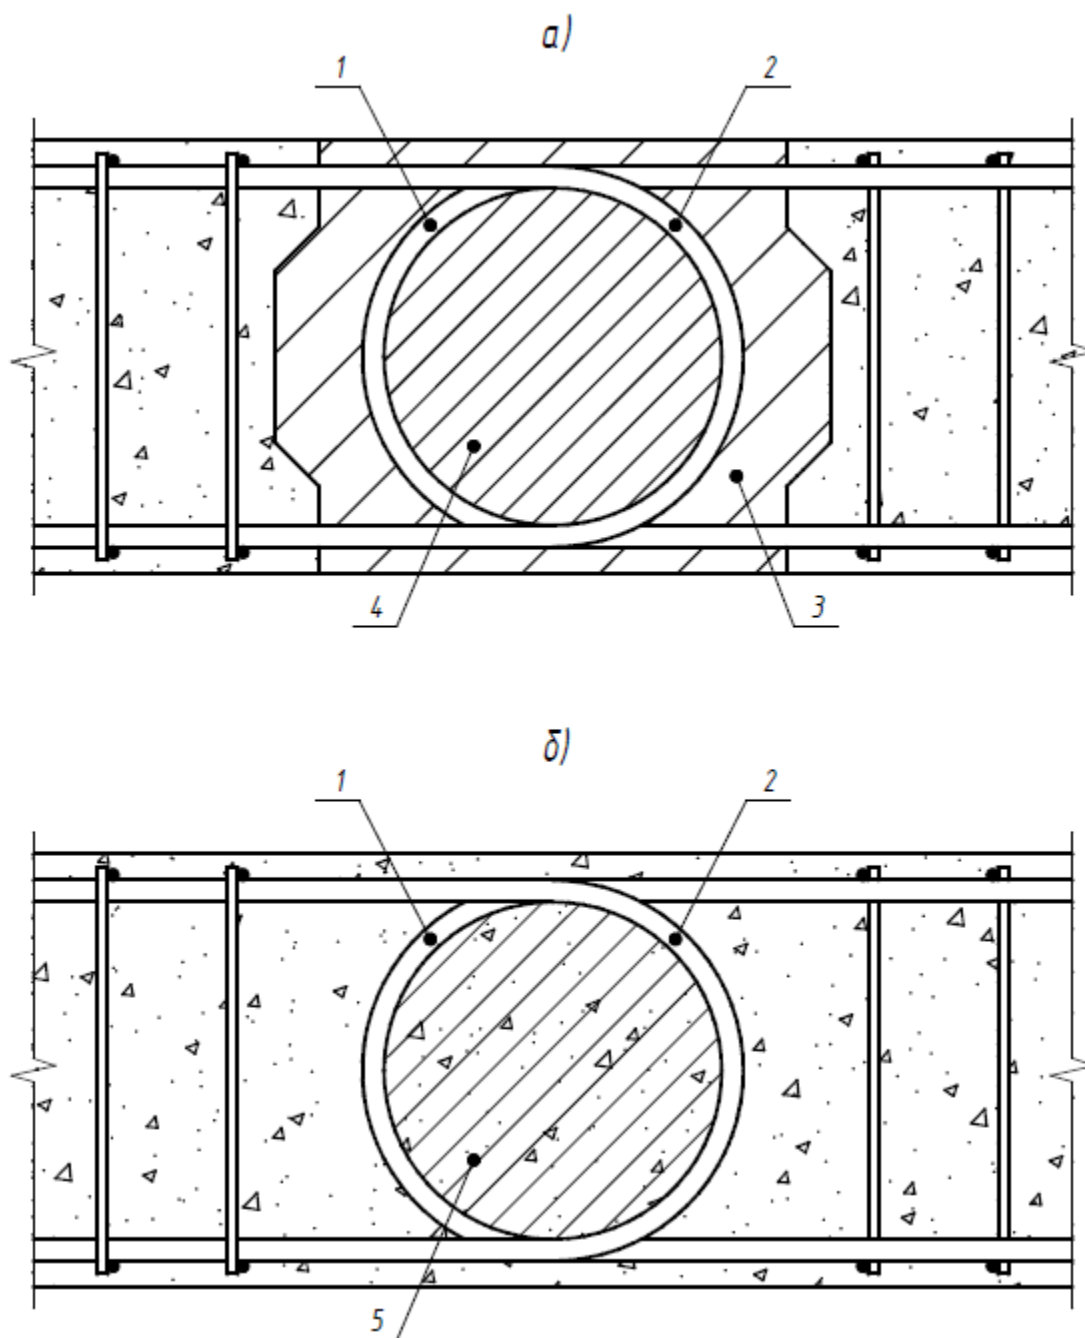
Петлевой стык стержневой арматуры железобетонных конструкций.
